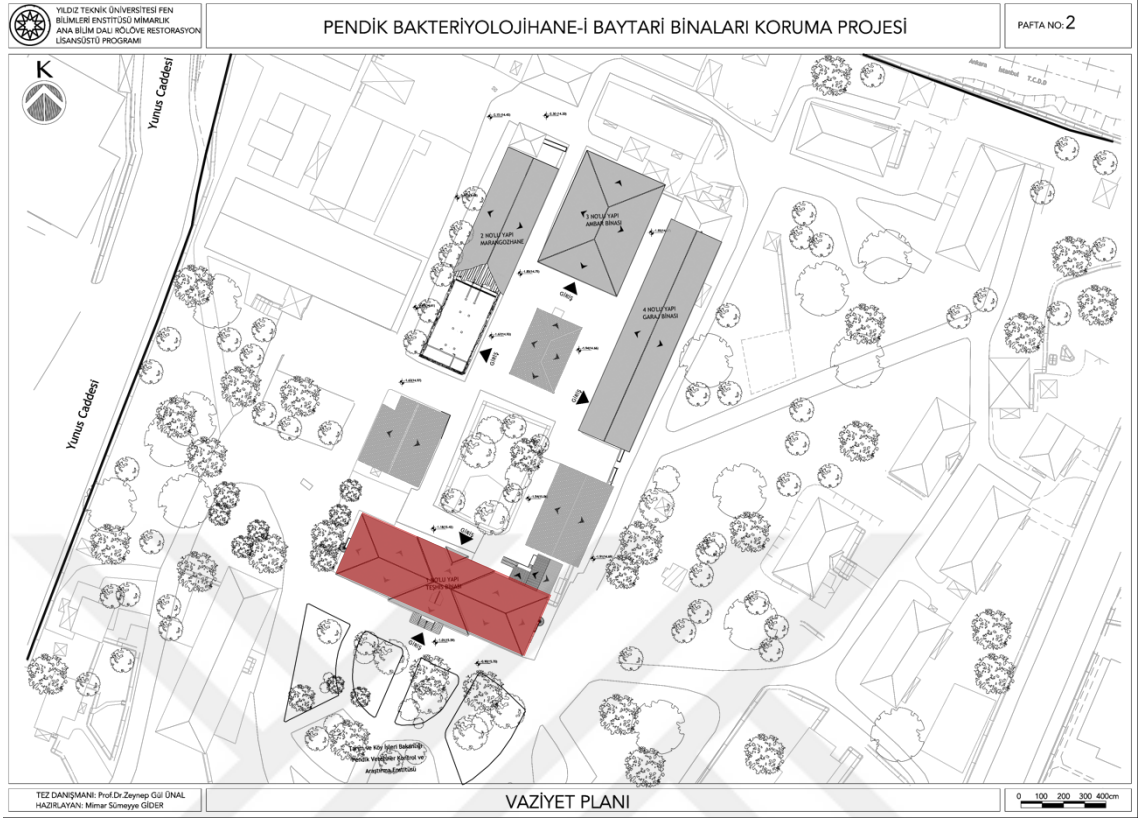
PVKAE Vaziyet Planı, 2018
